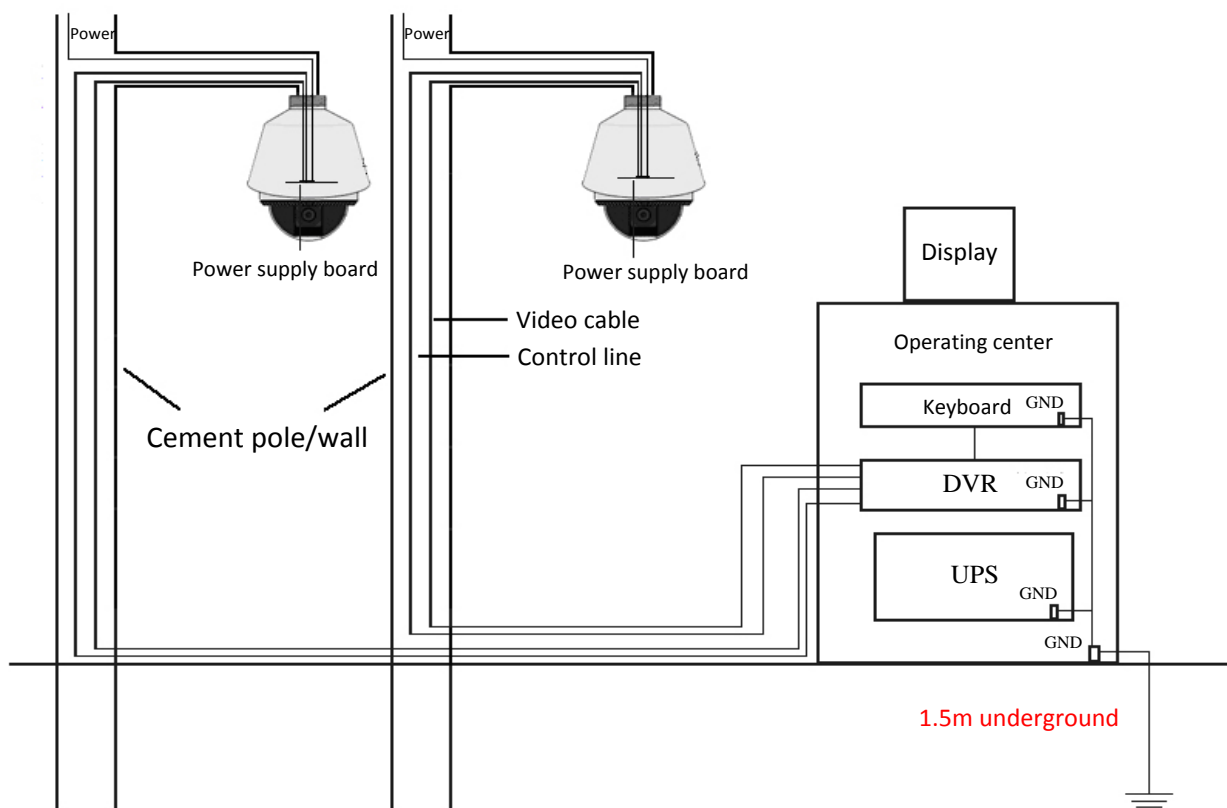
Împământarea la montajul pe stâlpi/pereti de ciment
